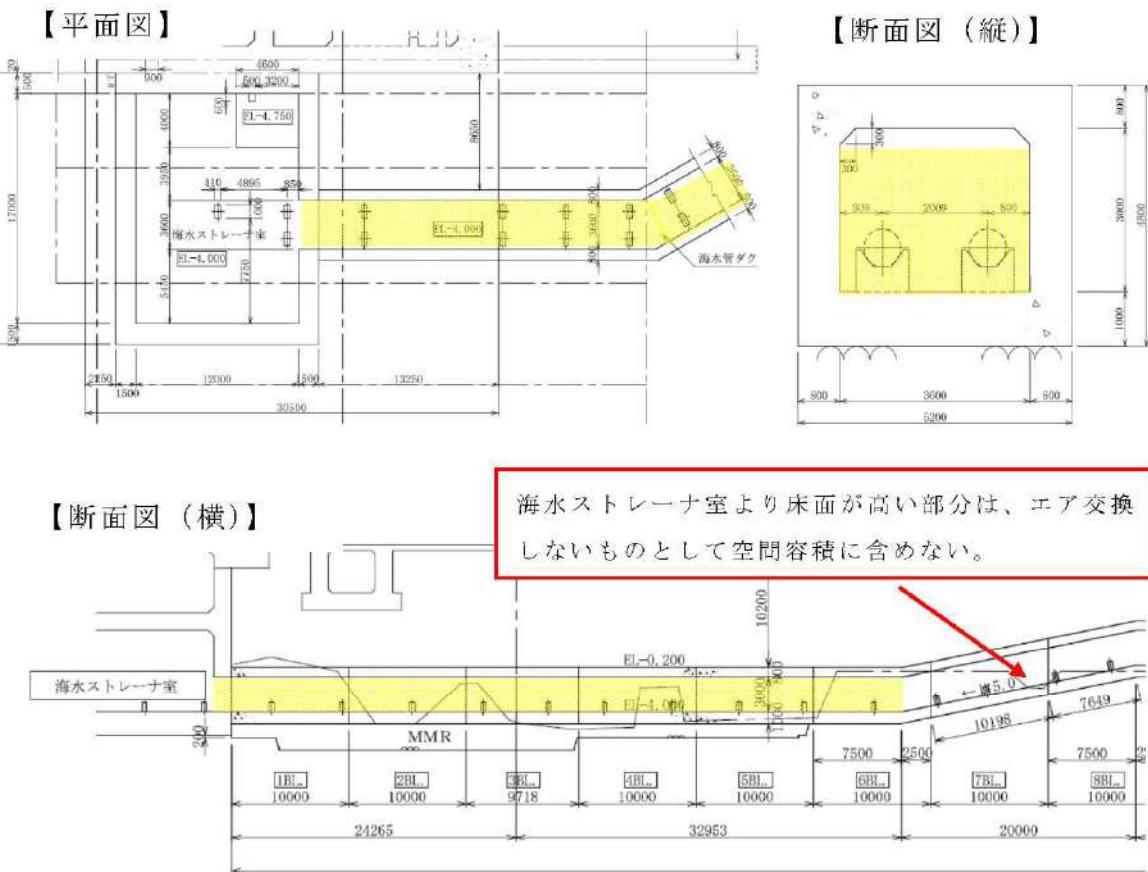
原子炉補機冷却海水管ダクト平面図及び断面図
